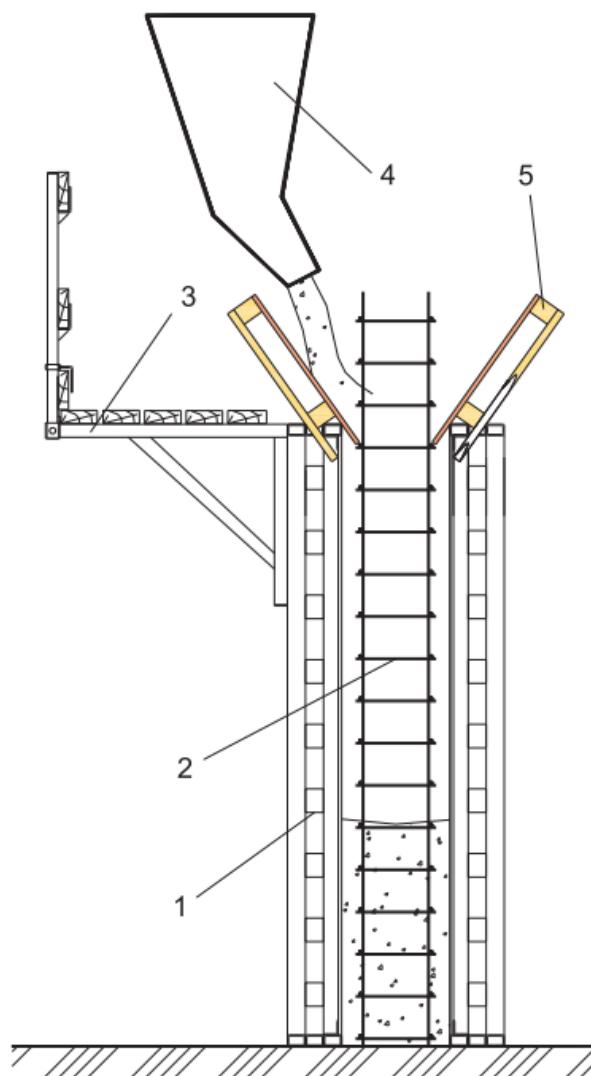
Схема укладання бетонної суміші в опалубку способом «кран-баддя»: 1 – щит опалубки; 2 – арматурний каркас з випусками; 3 – підмостки для бетонування; 4 – баддя з бічним розвантаженням; 5 – знімні фанерні лотки
